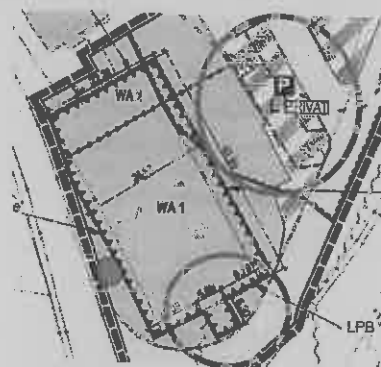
Entwurf zur erneuten Offenlage (aktueller Planstand mit Änderungen)
